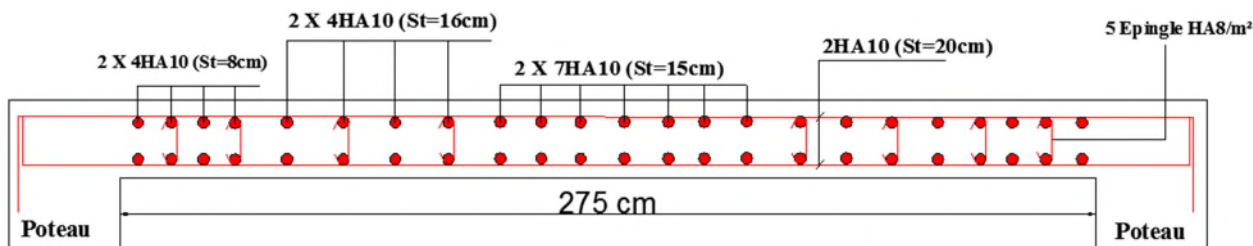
Schéma de ferrailage du Voile Vy1 (niveau entresol).
